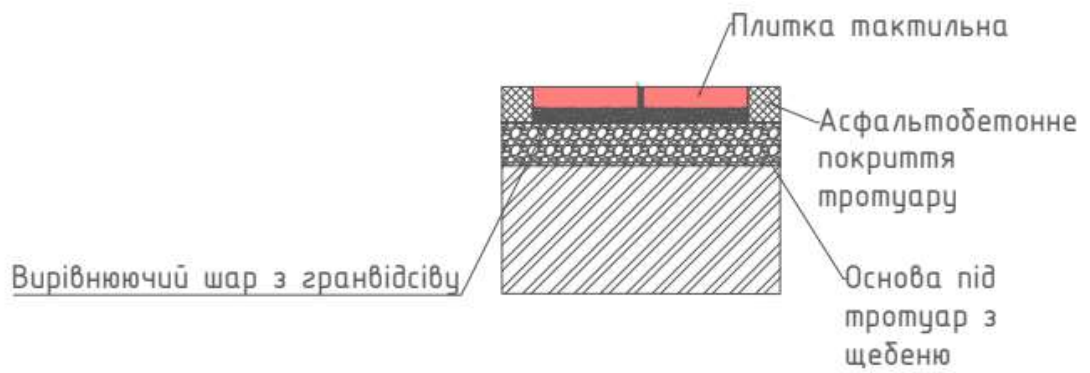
Конструкція установки тактильної плитки на асфальтобетонну основу
